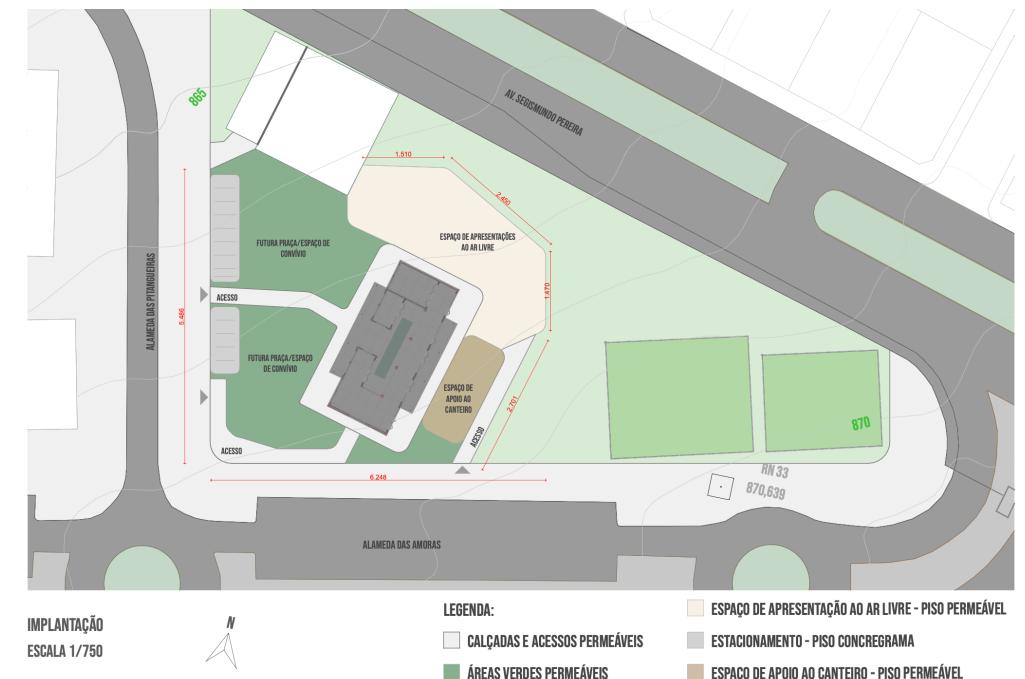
Planta de implantação preliminar. Fonte: Autora
